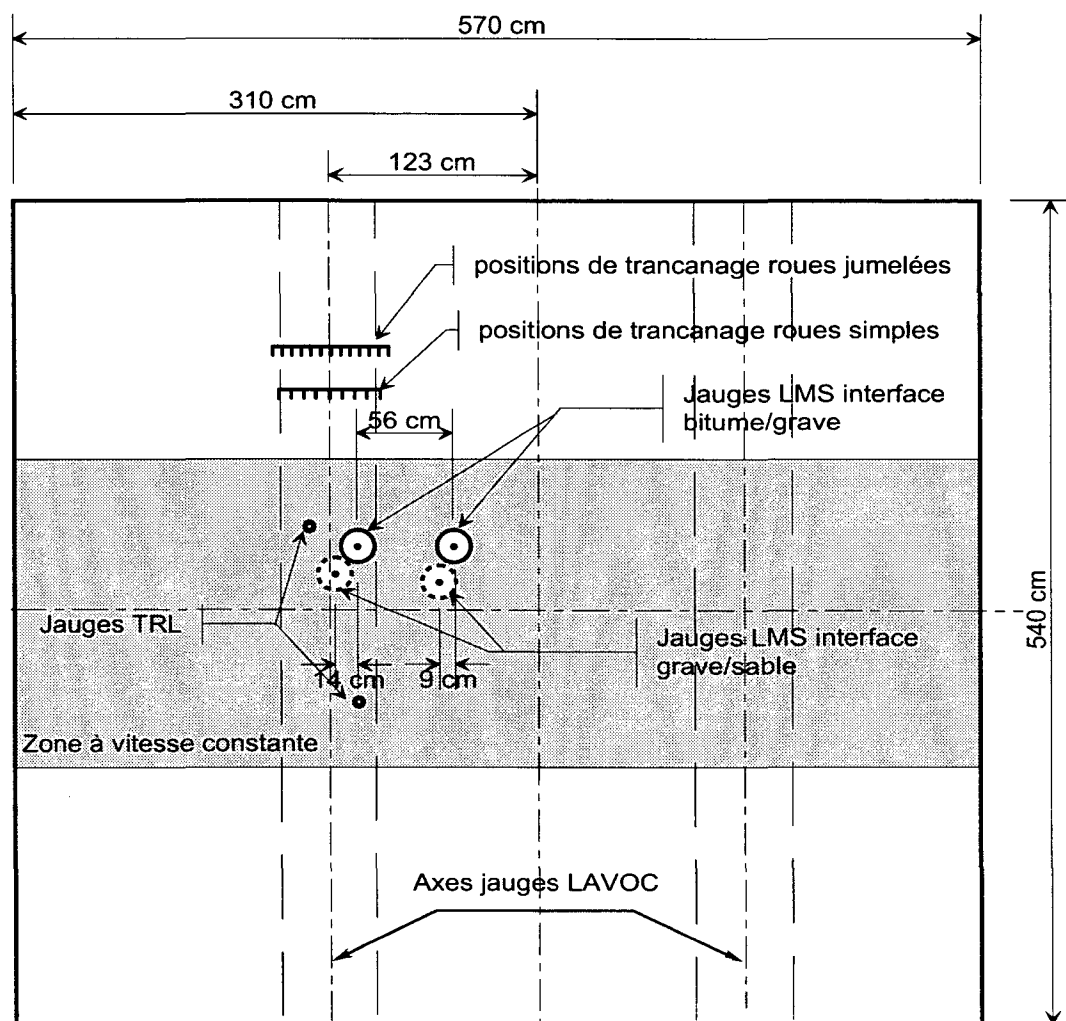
Géométrie de la planche d'essais : vue en plan
